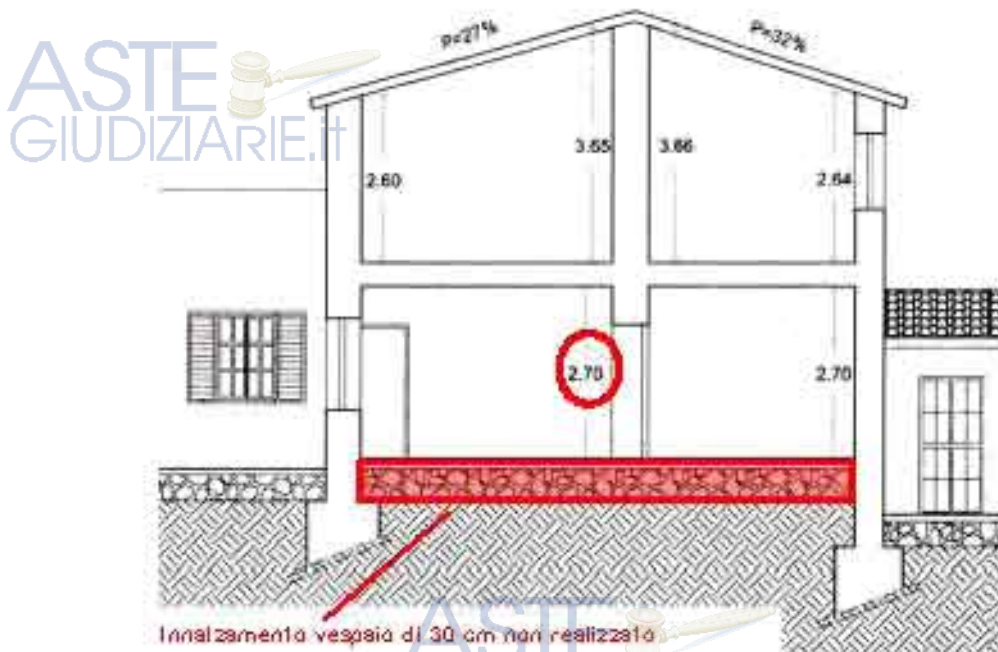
Elaborato grafico C.E. n°16 del 03/07/2002 – Sezione in progetto (post intervento)
